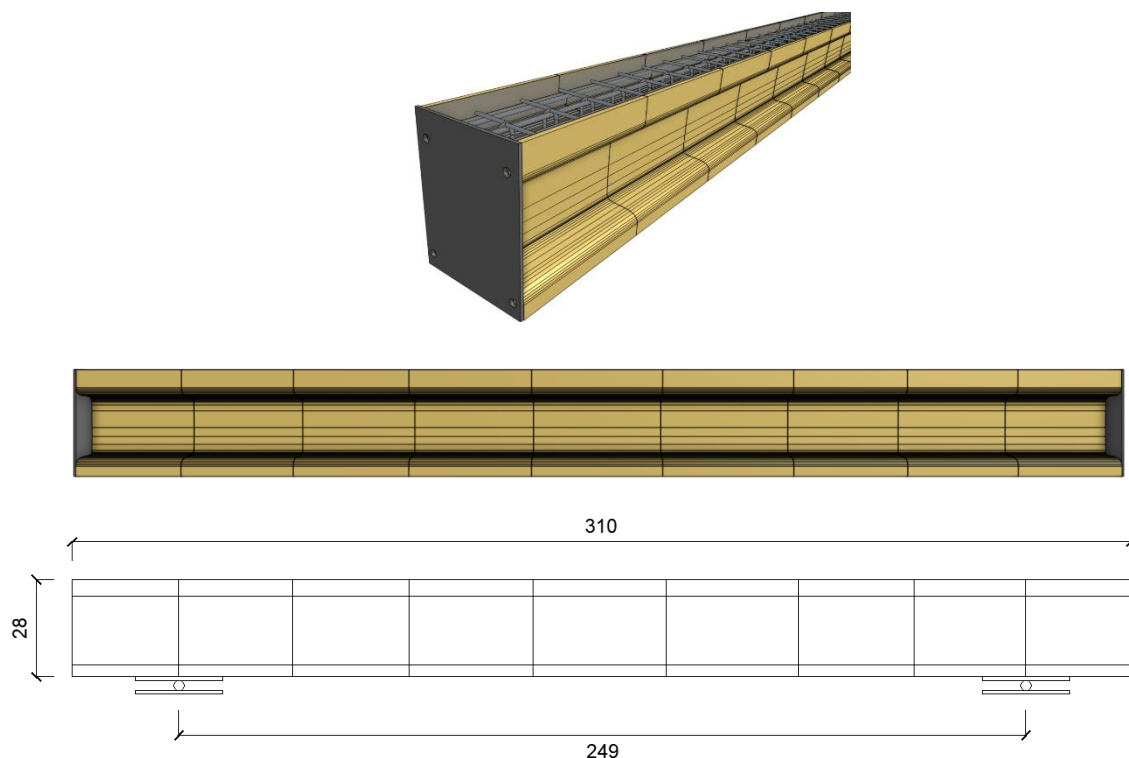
Vista en perspectiva y alzado viga híbrida. Dimensiones en centímetros.
